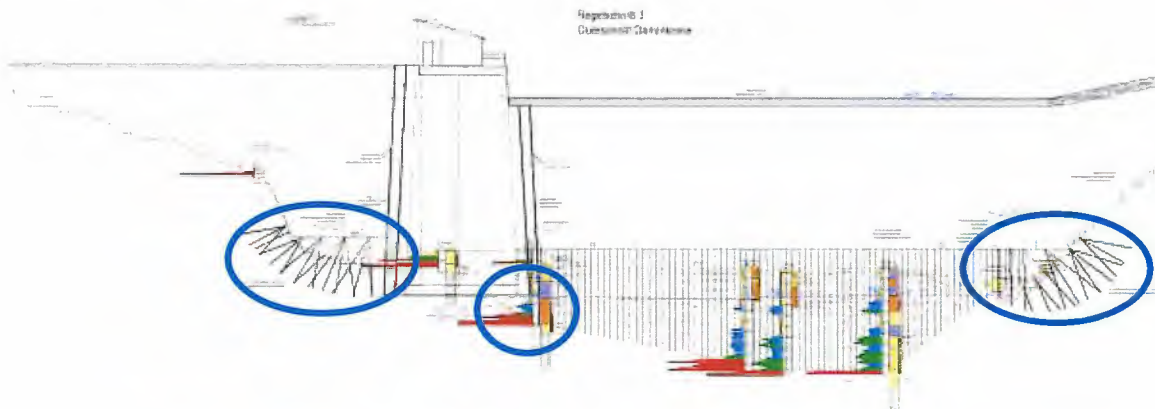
Lage der Betonscheiben; aus Plan 12.4.3
